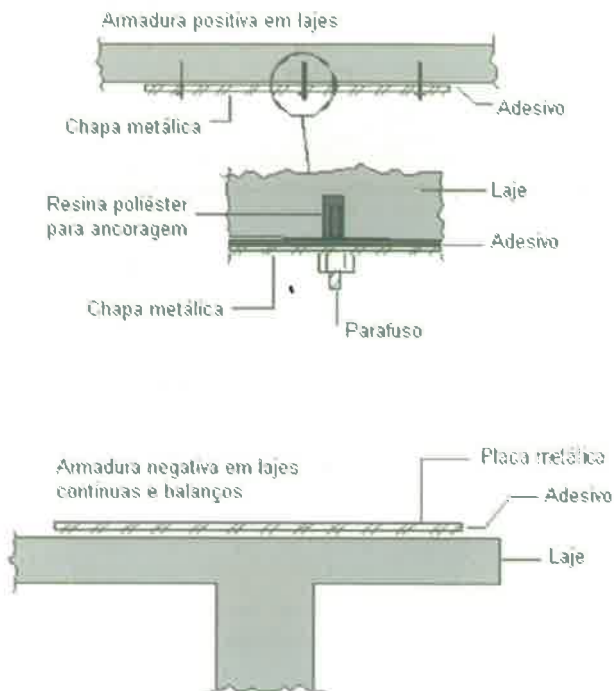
Reforço de flexão em lajes com chapas metálicas aderidas com epóxi.
